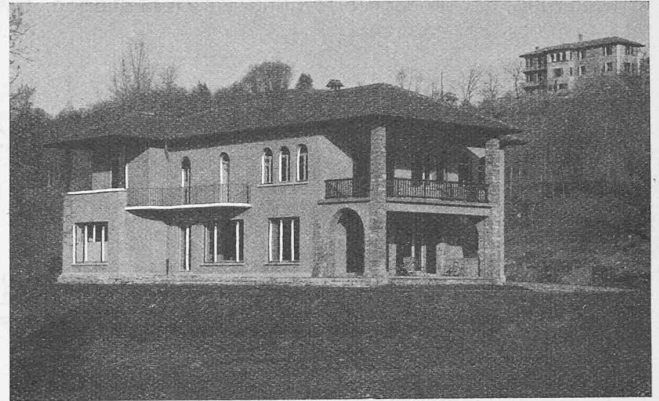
u. 50. Grundriss 1 : 400 und Ansicht des Arzthauses in Cadempino von Arch. G. ANTONINI, Lugano
